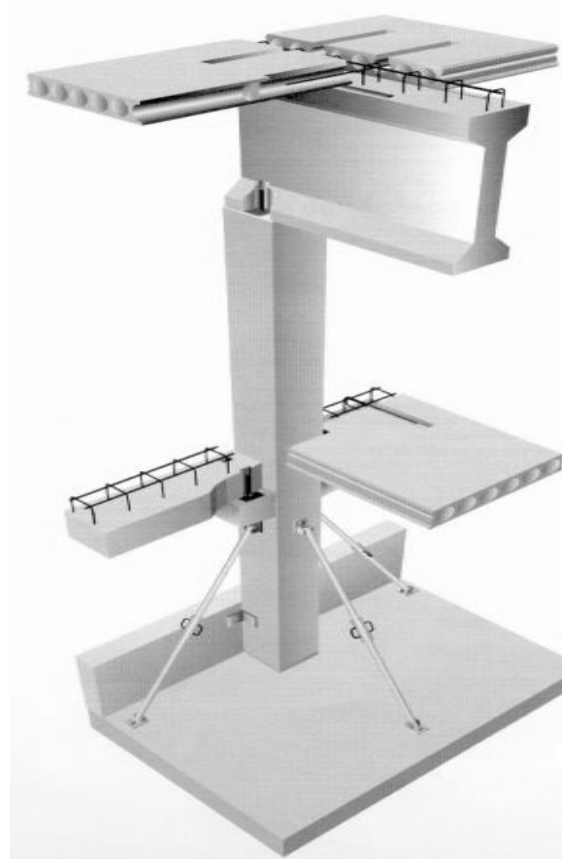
Esquema de ligações típicas de estruturas pré-fabricadas (extraído de Van Acker, 2007)
